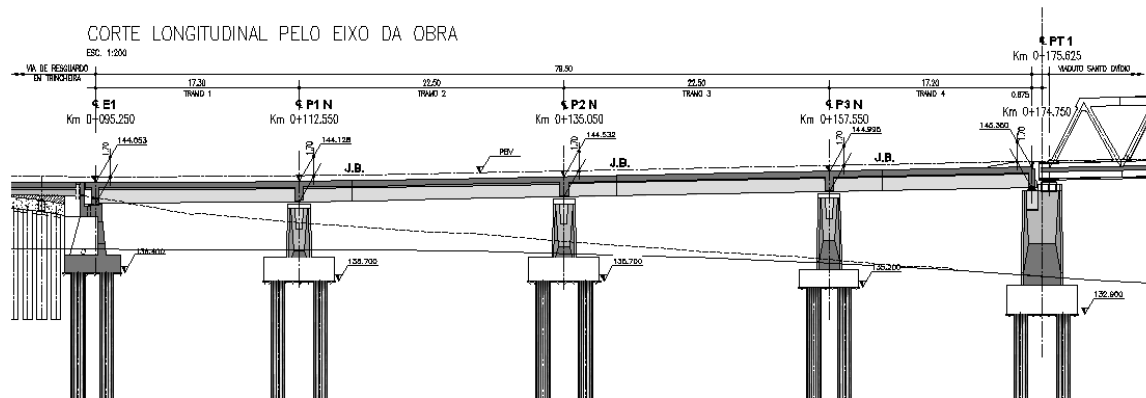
Corte longitudinal do Viaduto de Acesso Norte
